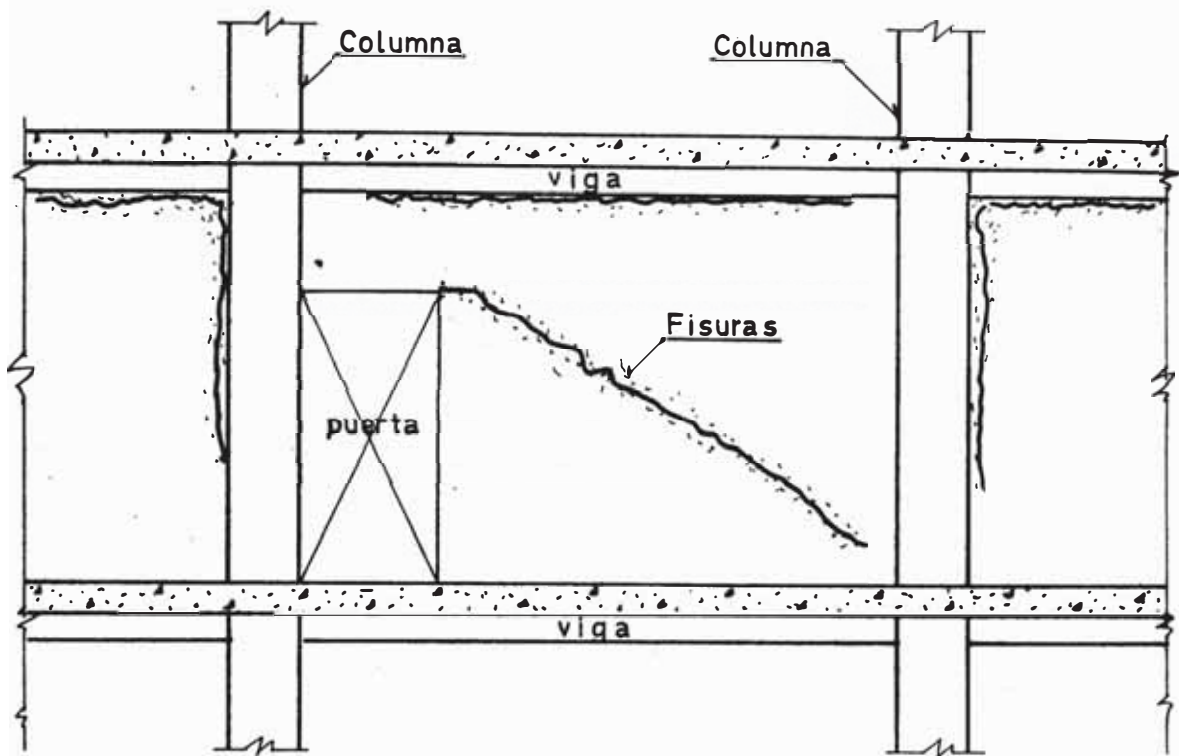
Fisuras en tabiques del Pab.Derecho, en la union con columnas y vigas. Corte típico junto a vano de puertas.
